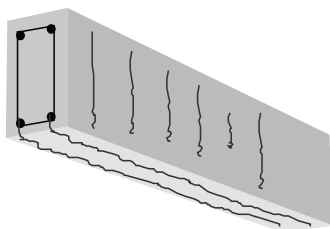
Fissuras provocadas por corrosão das armaduras internas
